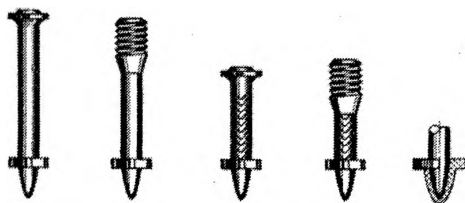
Дюбеля до будівельно-монтажного пістолета ПЦ52-1
